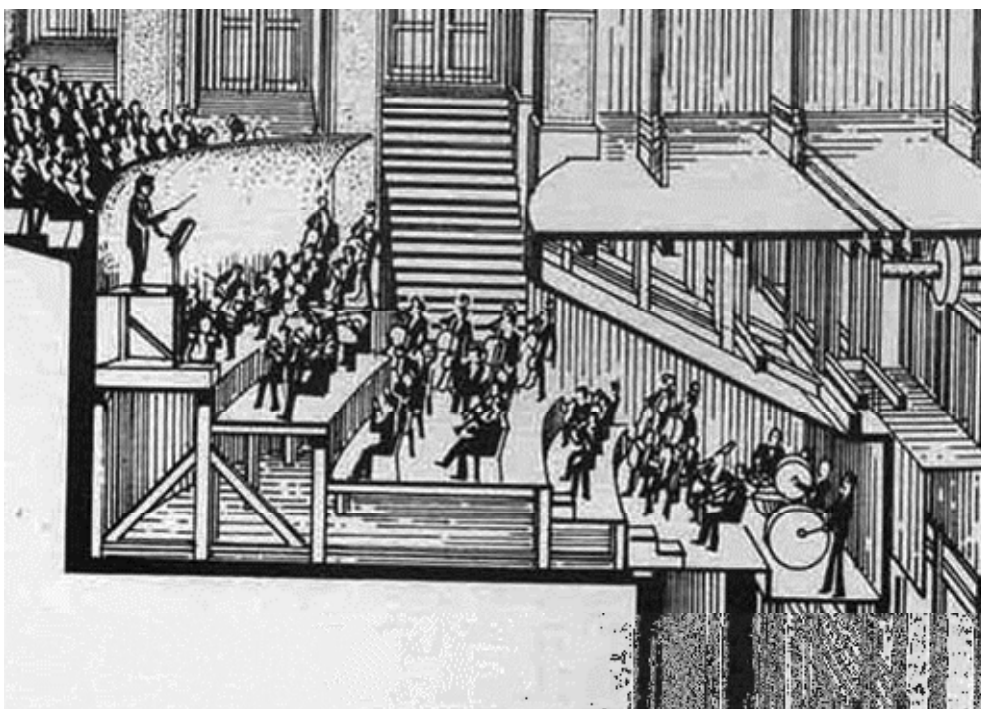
Bayreuther Festspielhaus, sezione longitudinale, particolare della buca dell'orchestra
